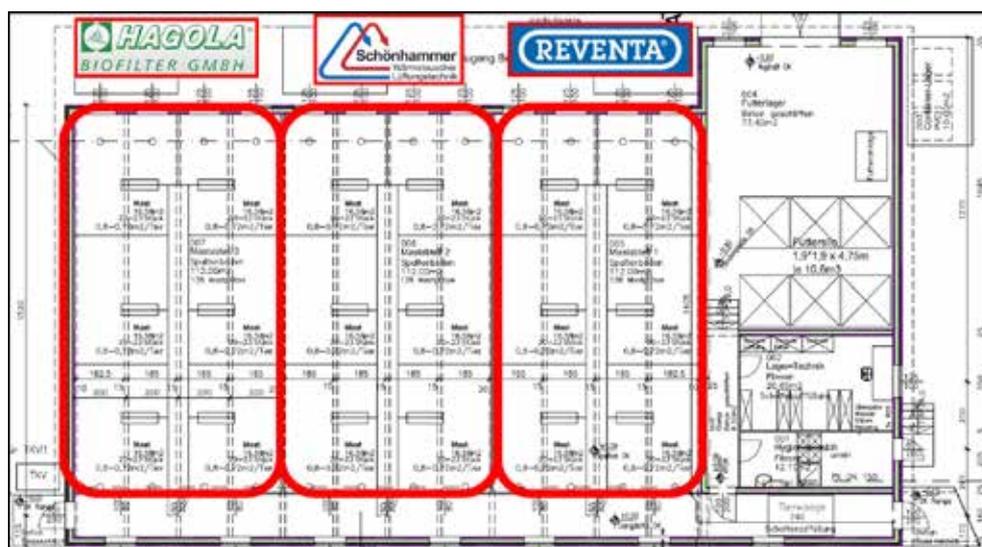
Grundriss des Schweineforschungsstalls der HBLFA Raumberg-Gumpenstein mit Positionierung der drei zu testenden Abluftreinigungsanlagen und Herstellerinformationen
